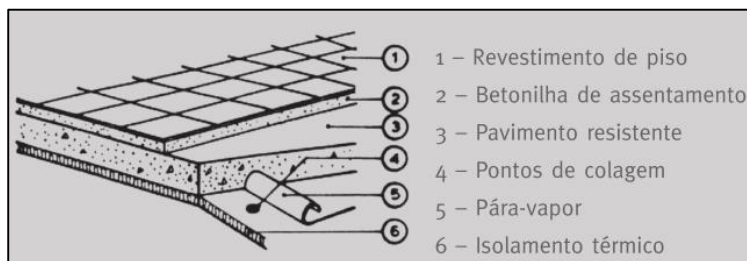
Pavimento sobre espaço exterior ou não aquecido – Isolamento térmico inferior[5]
